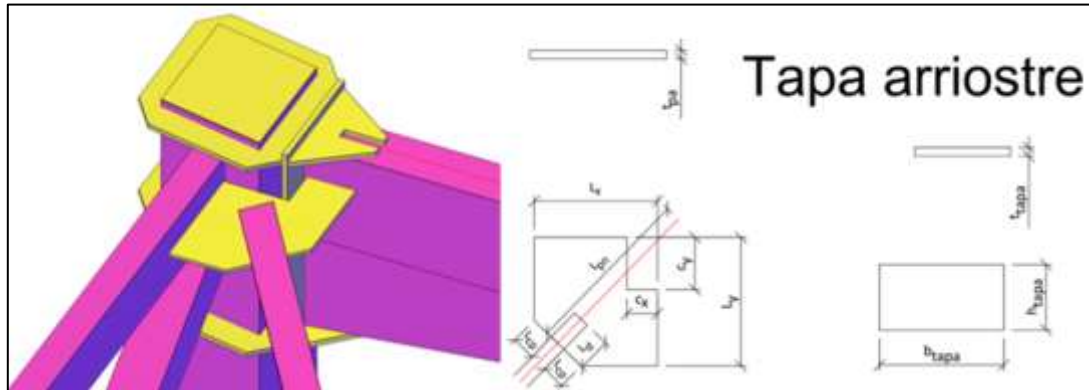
Conexión a corte Arriostre – Techo (Perfiles: tubulares)
